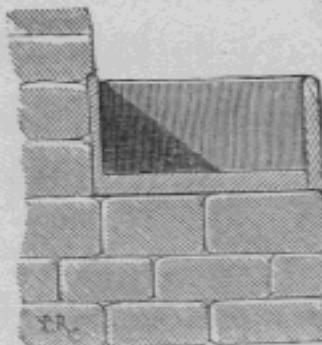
Coupe d'une auge à bord en bois et fond de ciment.
